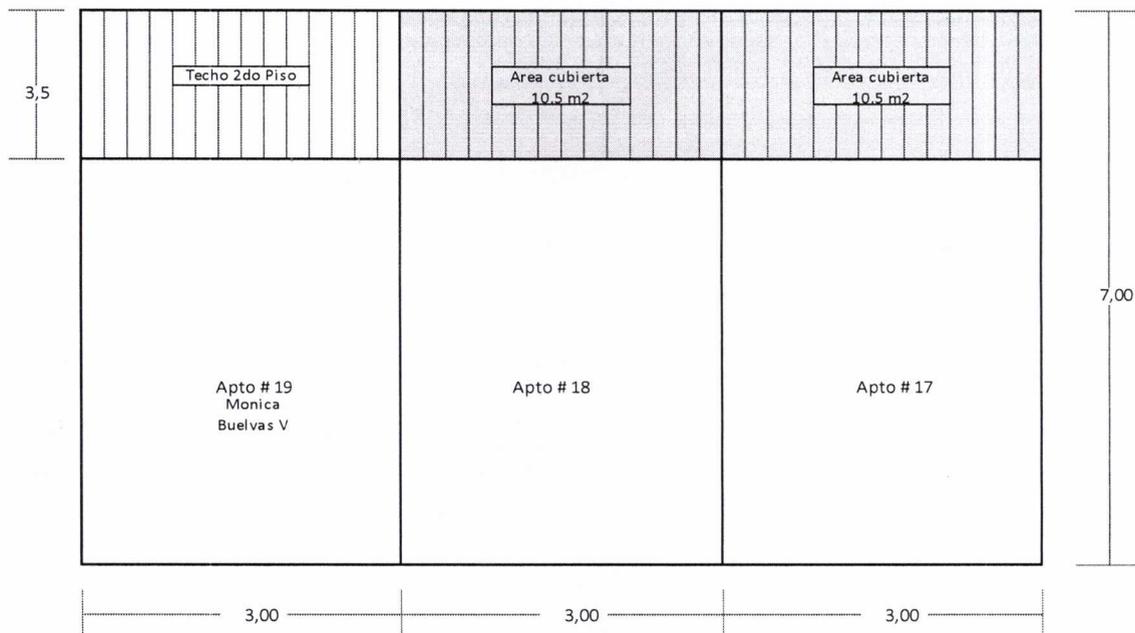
Levantamiento arquitectónico. Fuente: DCU 2022
